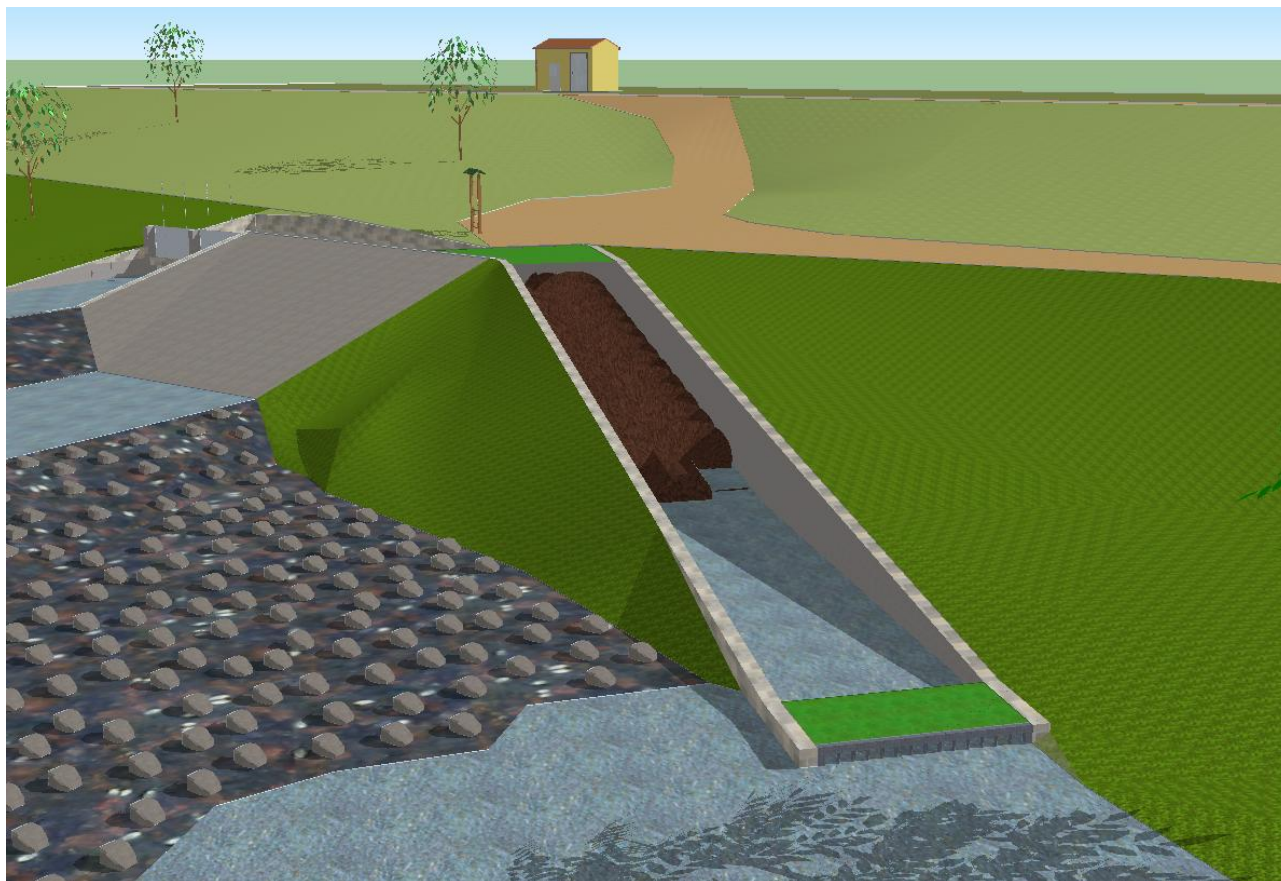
Rendering particolare manufatti impianto. Spaccato canale coclea.
